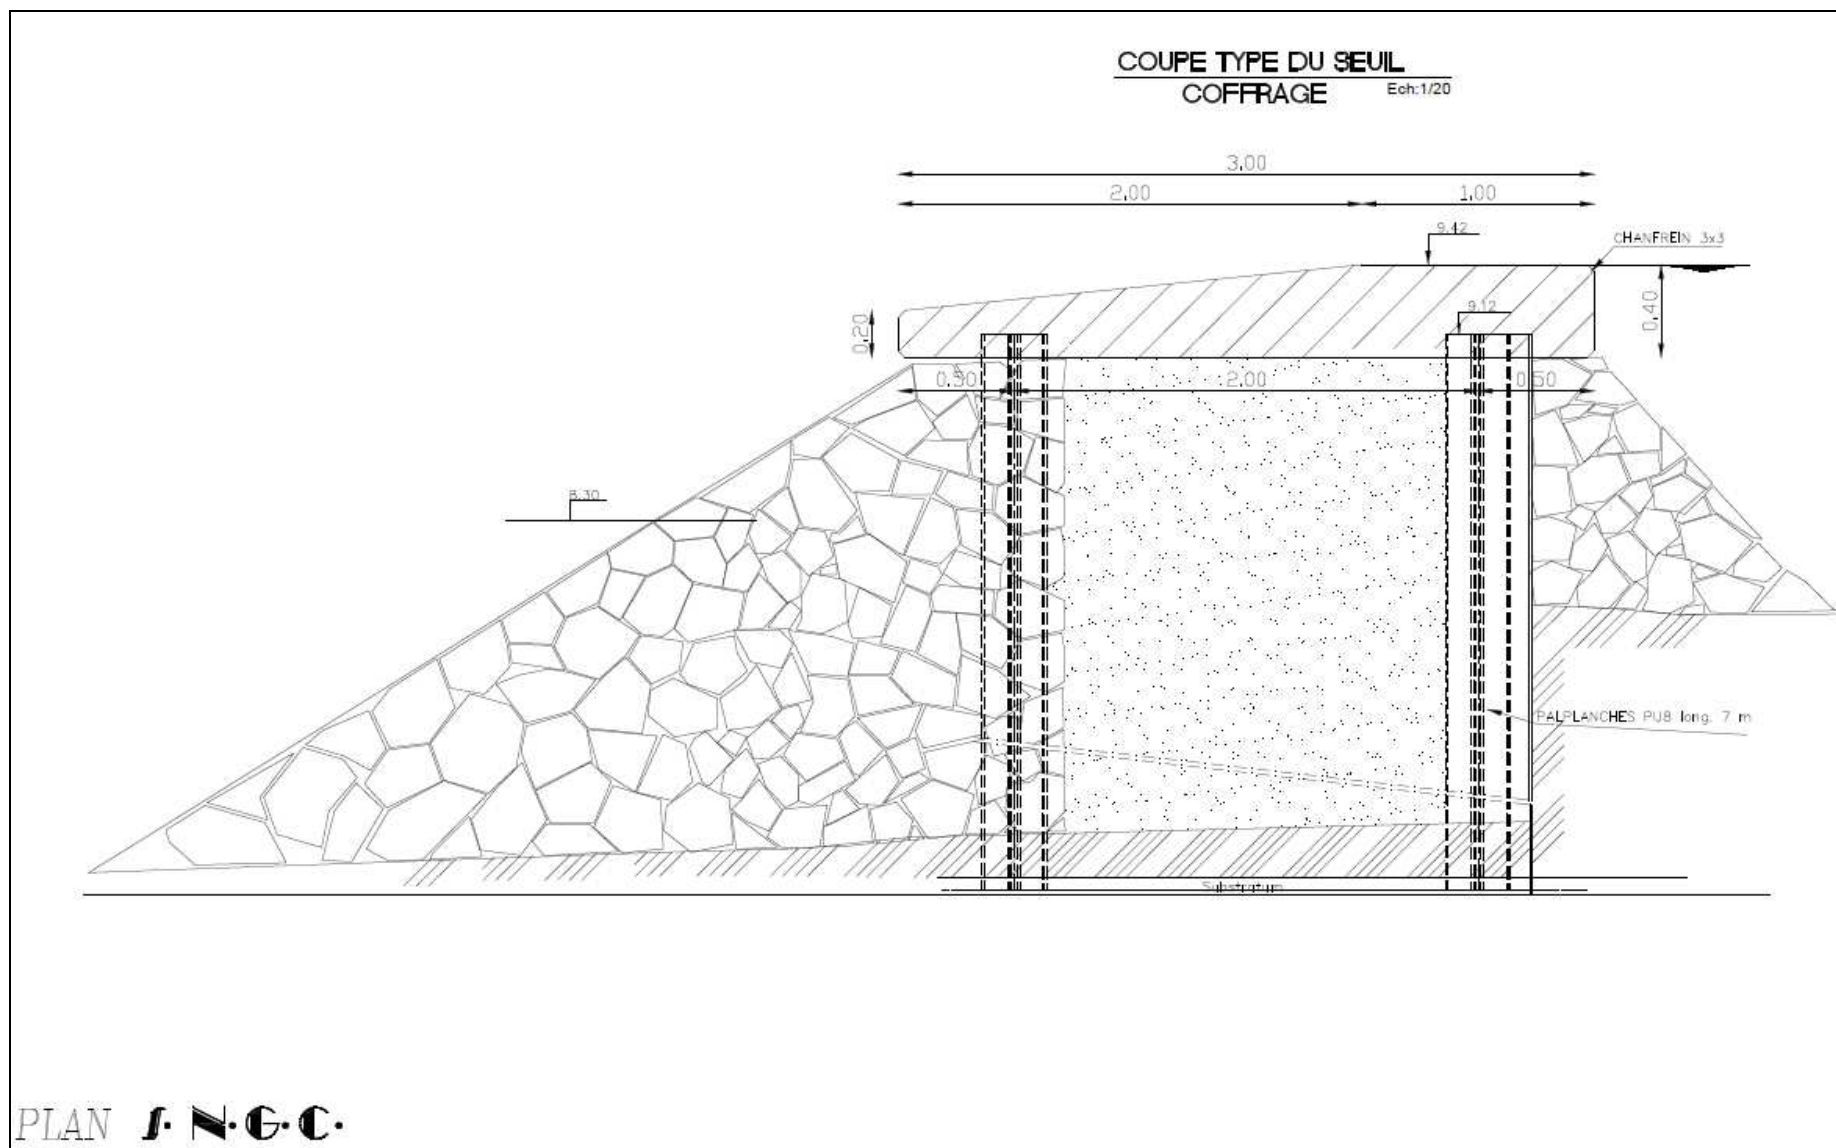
Plan et coupe du seuil et des vannages de Malvy
